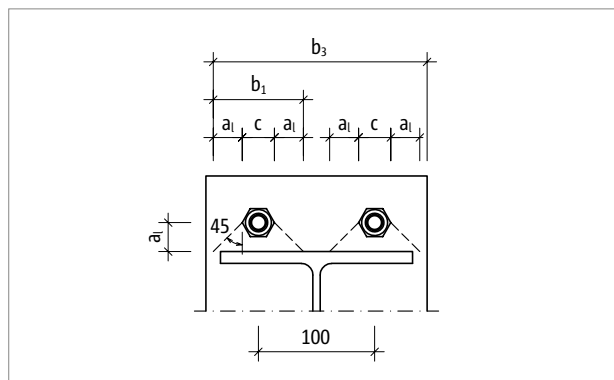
Platine frontale en saillie T type S : calcul des valeurs géométriques d'entrée ; vue de face
